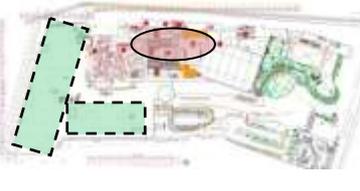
Zona vertikal fungsi ruang dalam BSM dan Trans Studio Bandung
